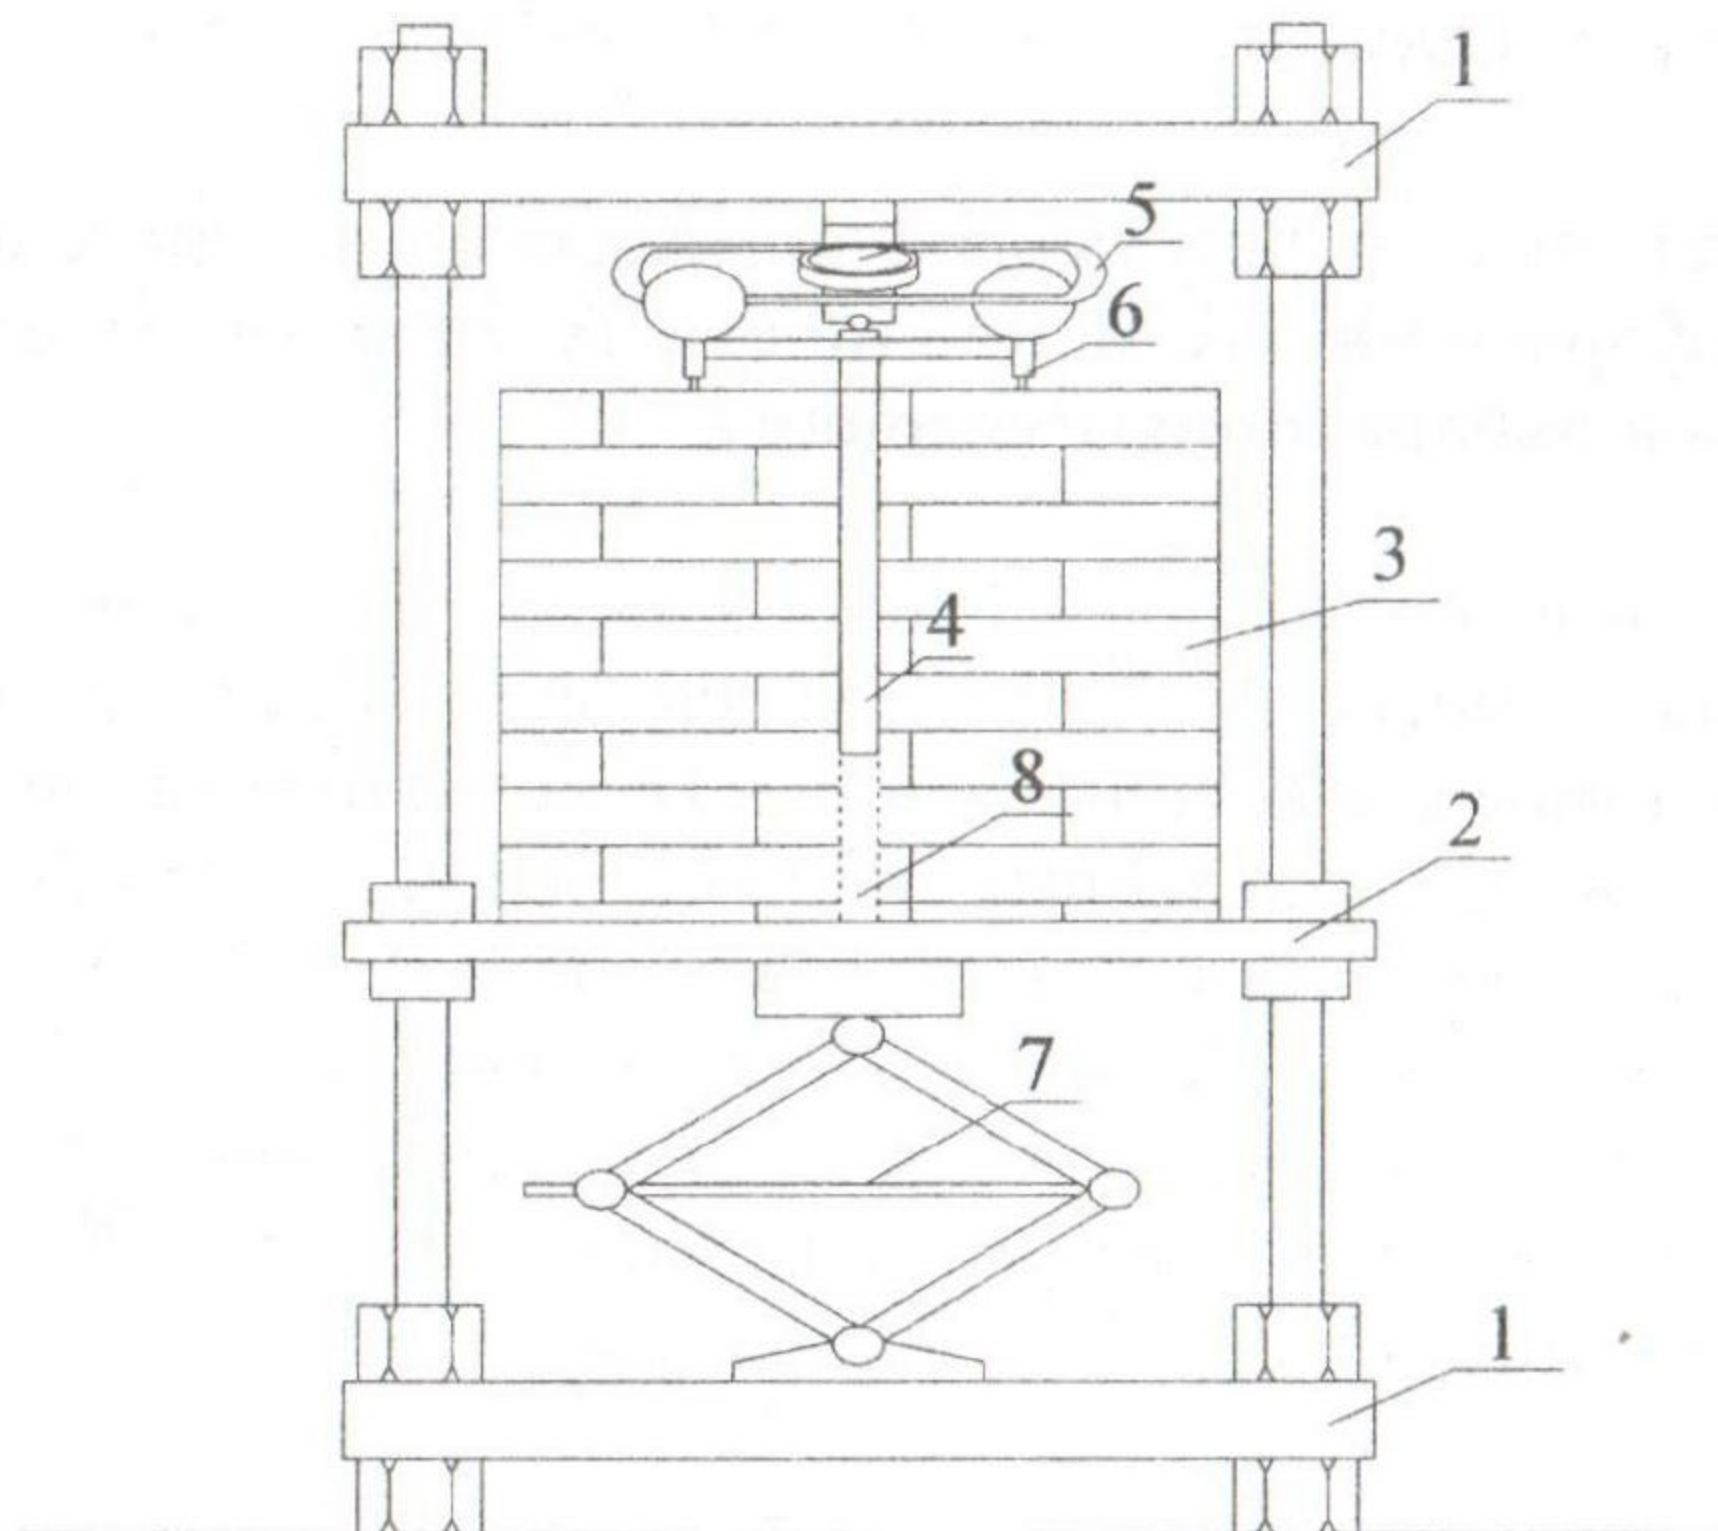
Схема силовой установки для испытания известняка-ракушечника буронабивными сваями: 1- неподвижная пластина; 2 - подвижная пластина; 3 – опытный образец 4 - буронабивная свая; 5 - динамометр; 6 - индикаторы часового типа; 7- домкрат; 8 – полость под подошвой сваи.
